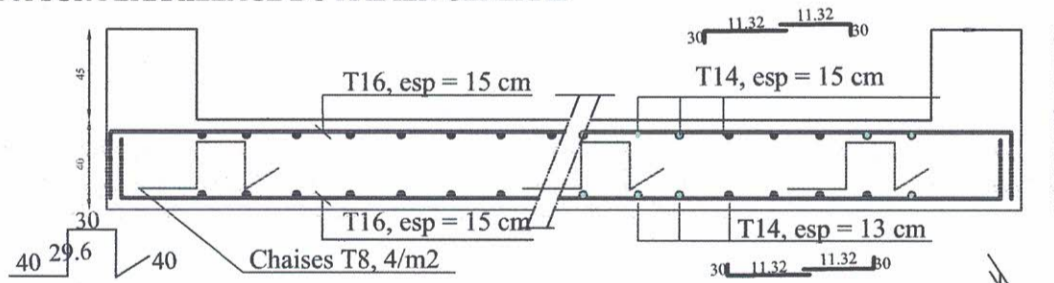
DETAIL SUR FERRAILLAGE NERVURES EN TRAVÉE SENS XX et YY
